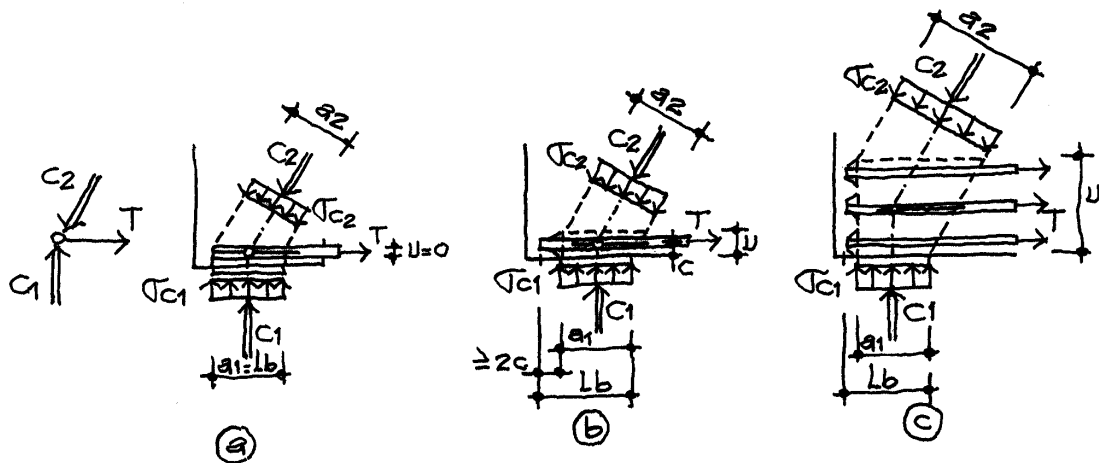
Nudos donde se anclan armaduras, condicionado por la geometría de un apoyo y la disposición de armadura del tirante que se ancla en él
